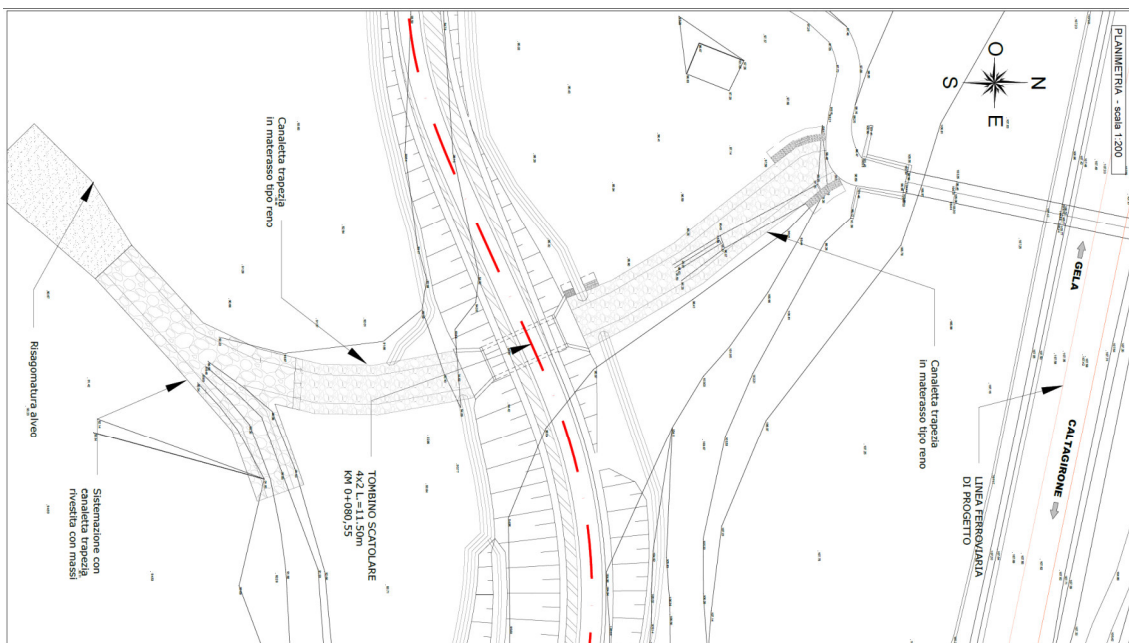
Inquadramento planimetrico Tombino e sistemazione idraulica
